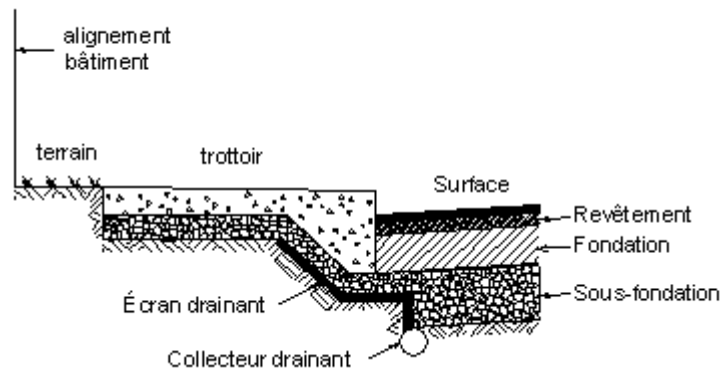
Drainage par écran drainant incliné en rive de chaussée
